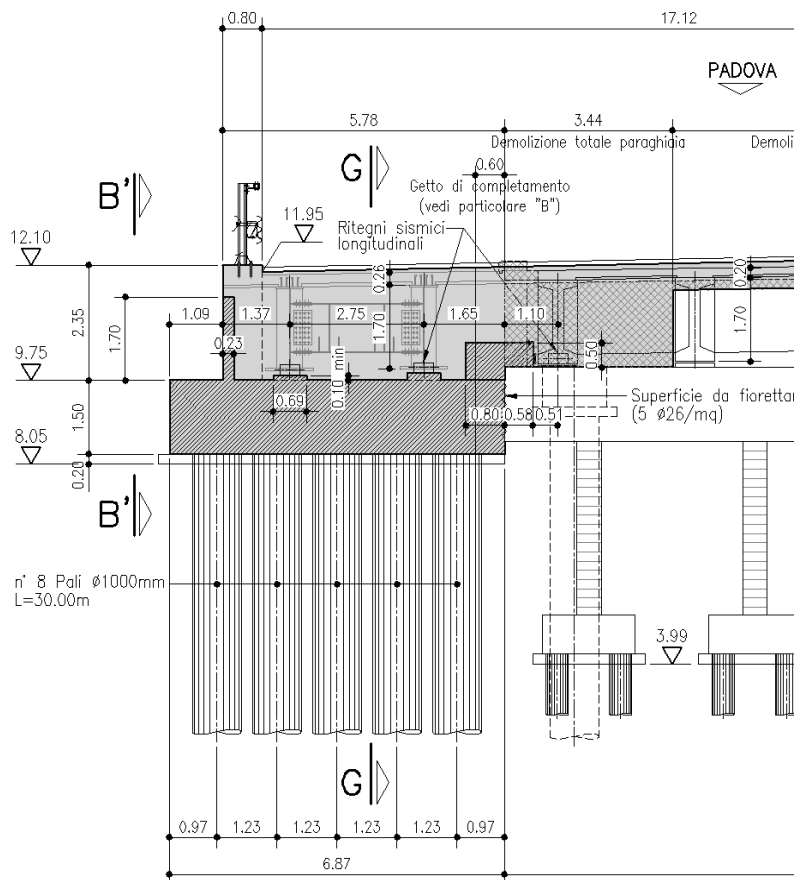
Semi-prospetto spalle con ampliamento
